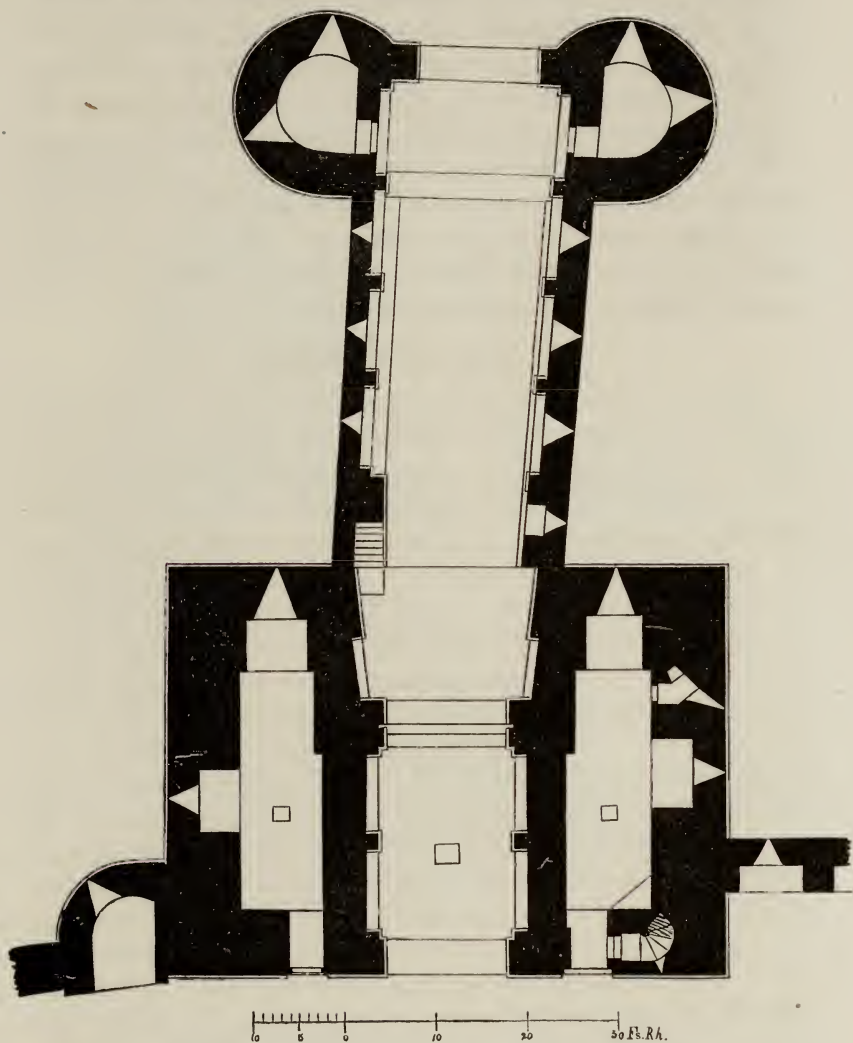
Grundriß des Aachener Pontthores zur ebenen Erde.
